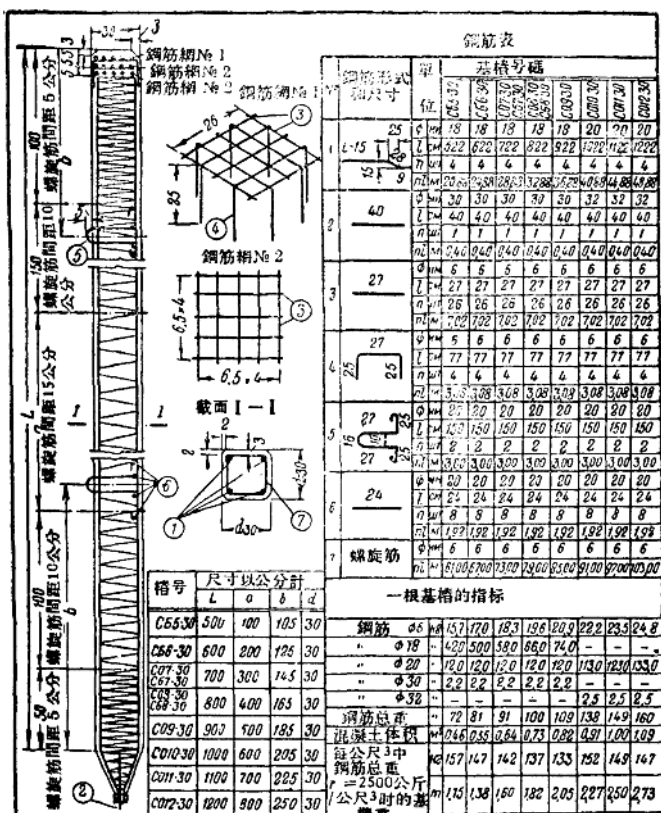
30×30公分的钢筋混凝土桩的钢筋布置
